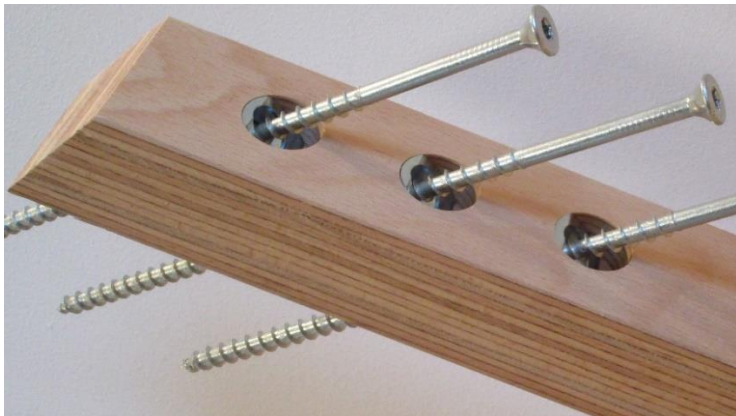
Winkelscheibe 45° Hartholz mit ASSY 3.0 Teilgewindeschrauben in Baubuche
